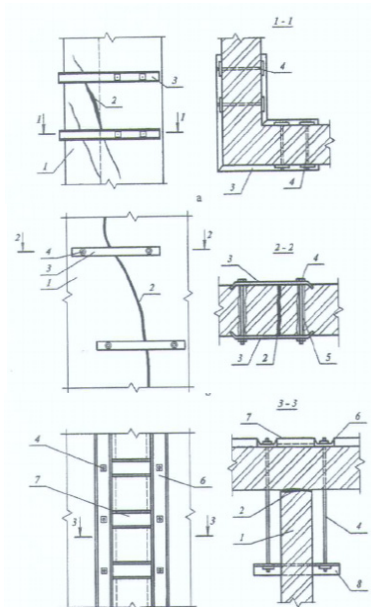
Схема усиления стен из каменной кладки в зонах локальных трещин металлическими элементами
